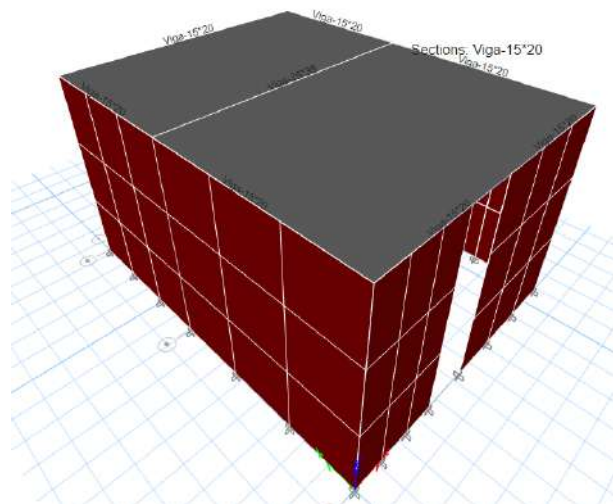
Vista en planta del modelamiento de la vivienda 05
